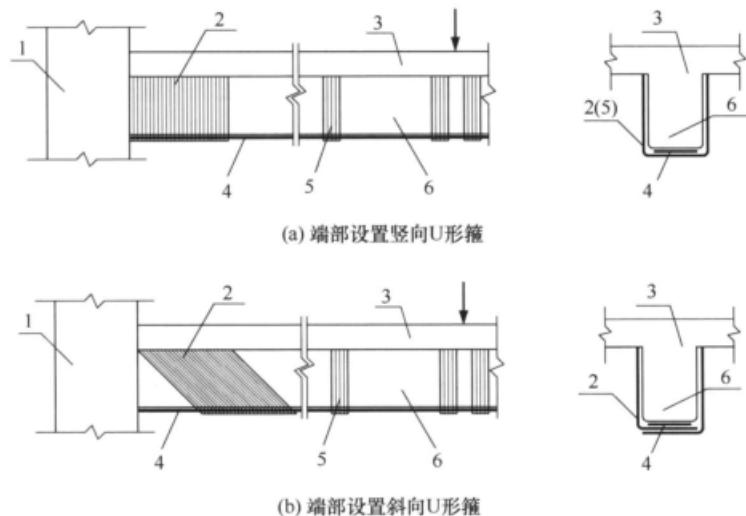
梁跨中受弯加固 U 形箍构造示意图
